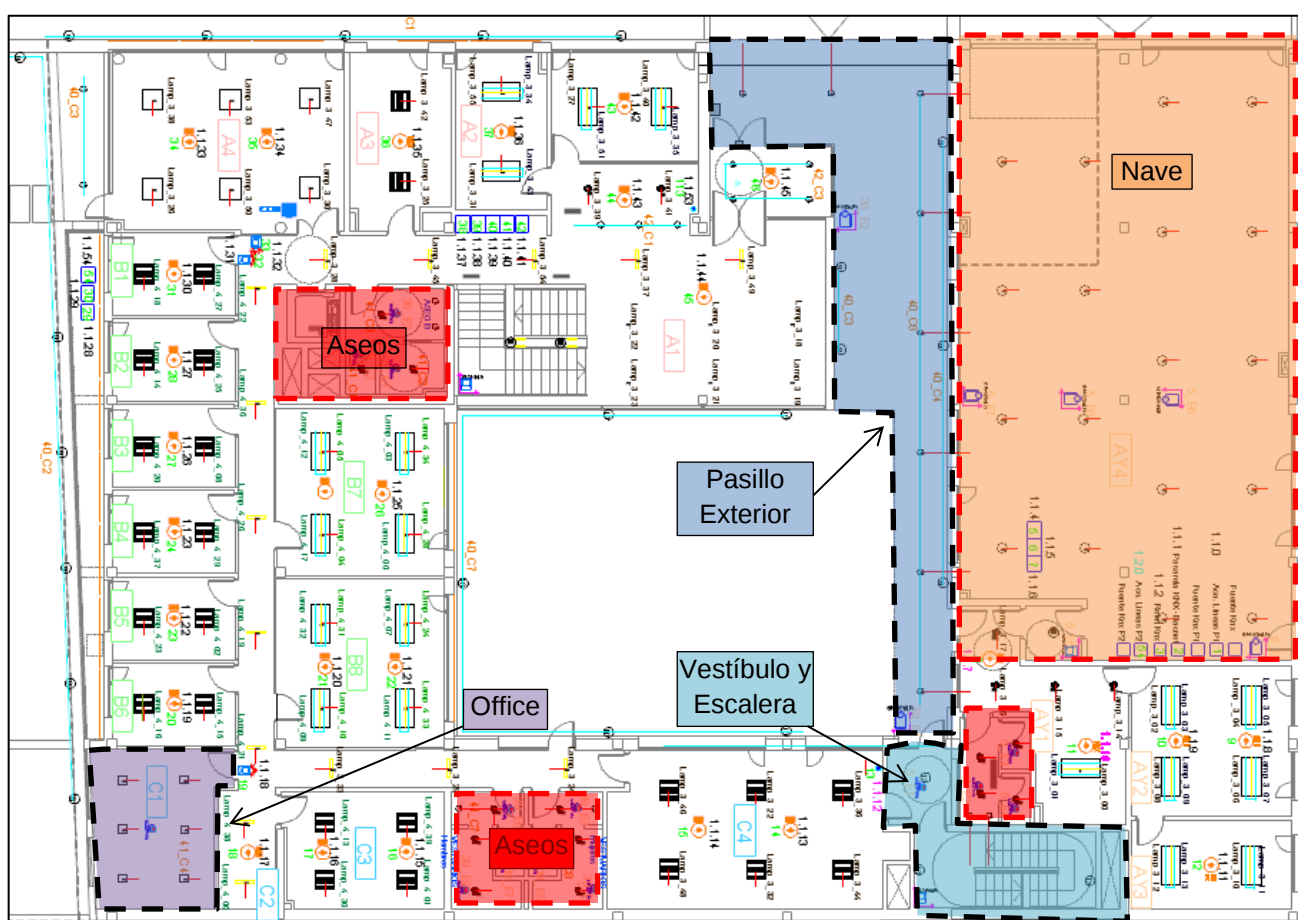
Planta Baja del Edificio. Zonas donde se han instalado detectores convencionales conectados a módulos de entradas digitales KNX
